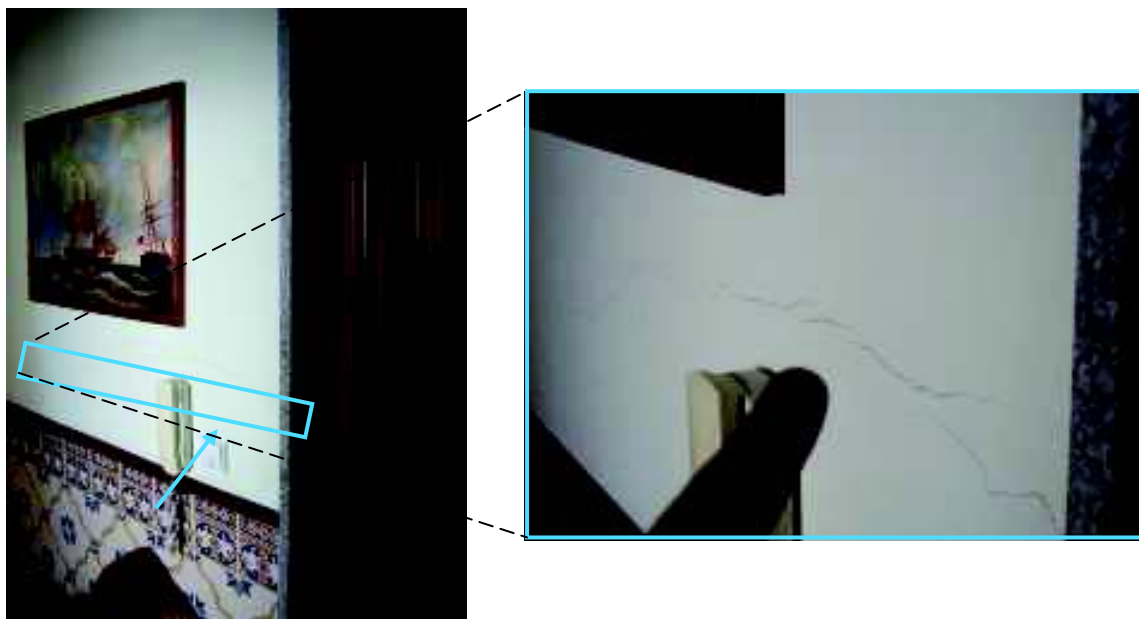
Fissuras horizontais em paredes de alvenaria
